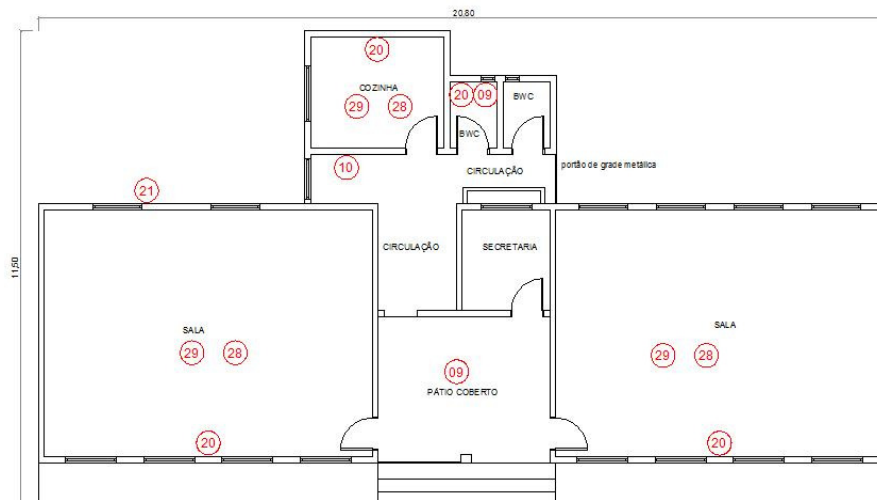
Planta Baixa creche Procópio Lima – Barracão
